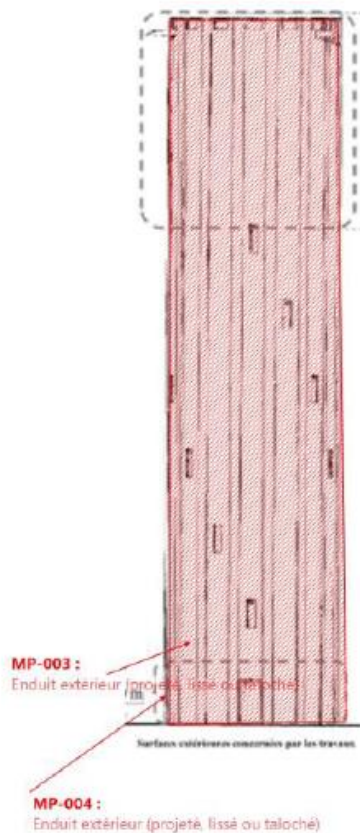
Présence d'amiante (en rouge) sur façade du bâtiment Z10
